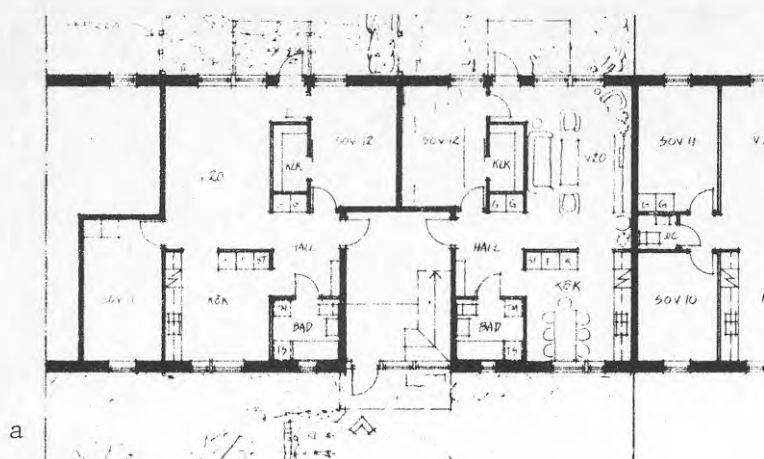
,b,c Tre informationstidningsversioner av K-konsults situationsplan.
